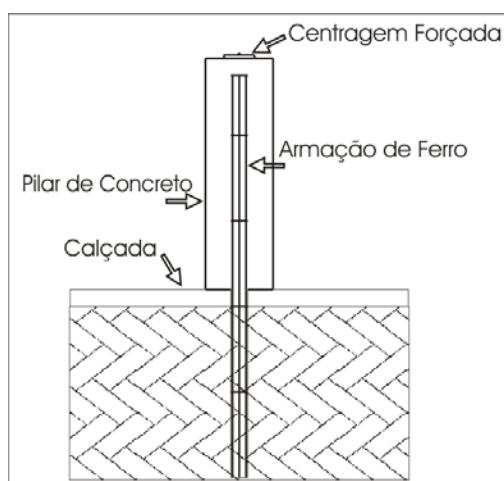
Projeto de Pilar da Rede de Monitoramento
